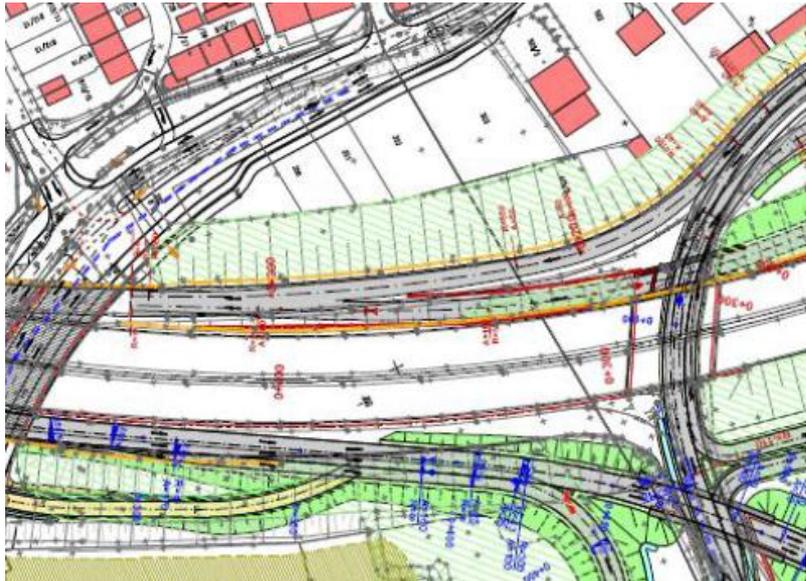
Situation Direktanbindung/Auffahrtsrampe Variante 5 West
